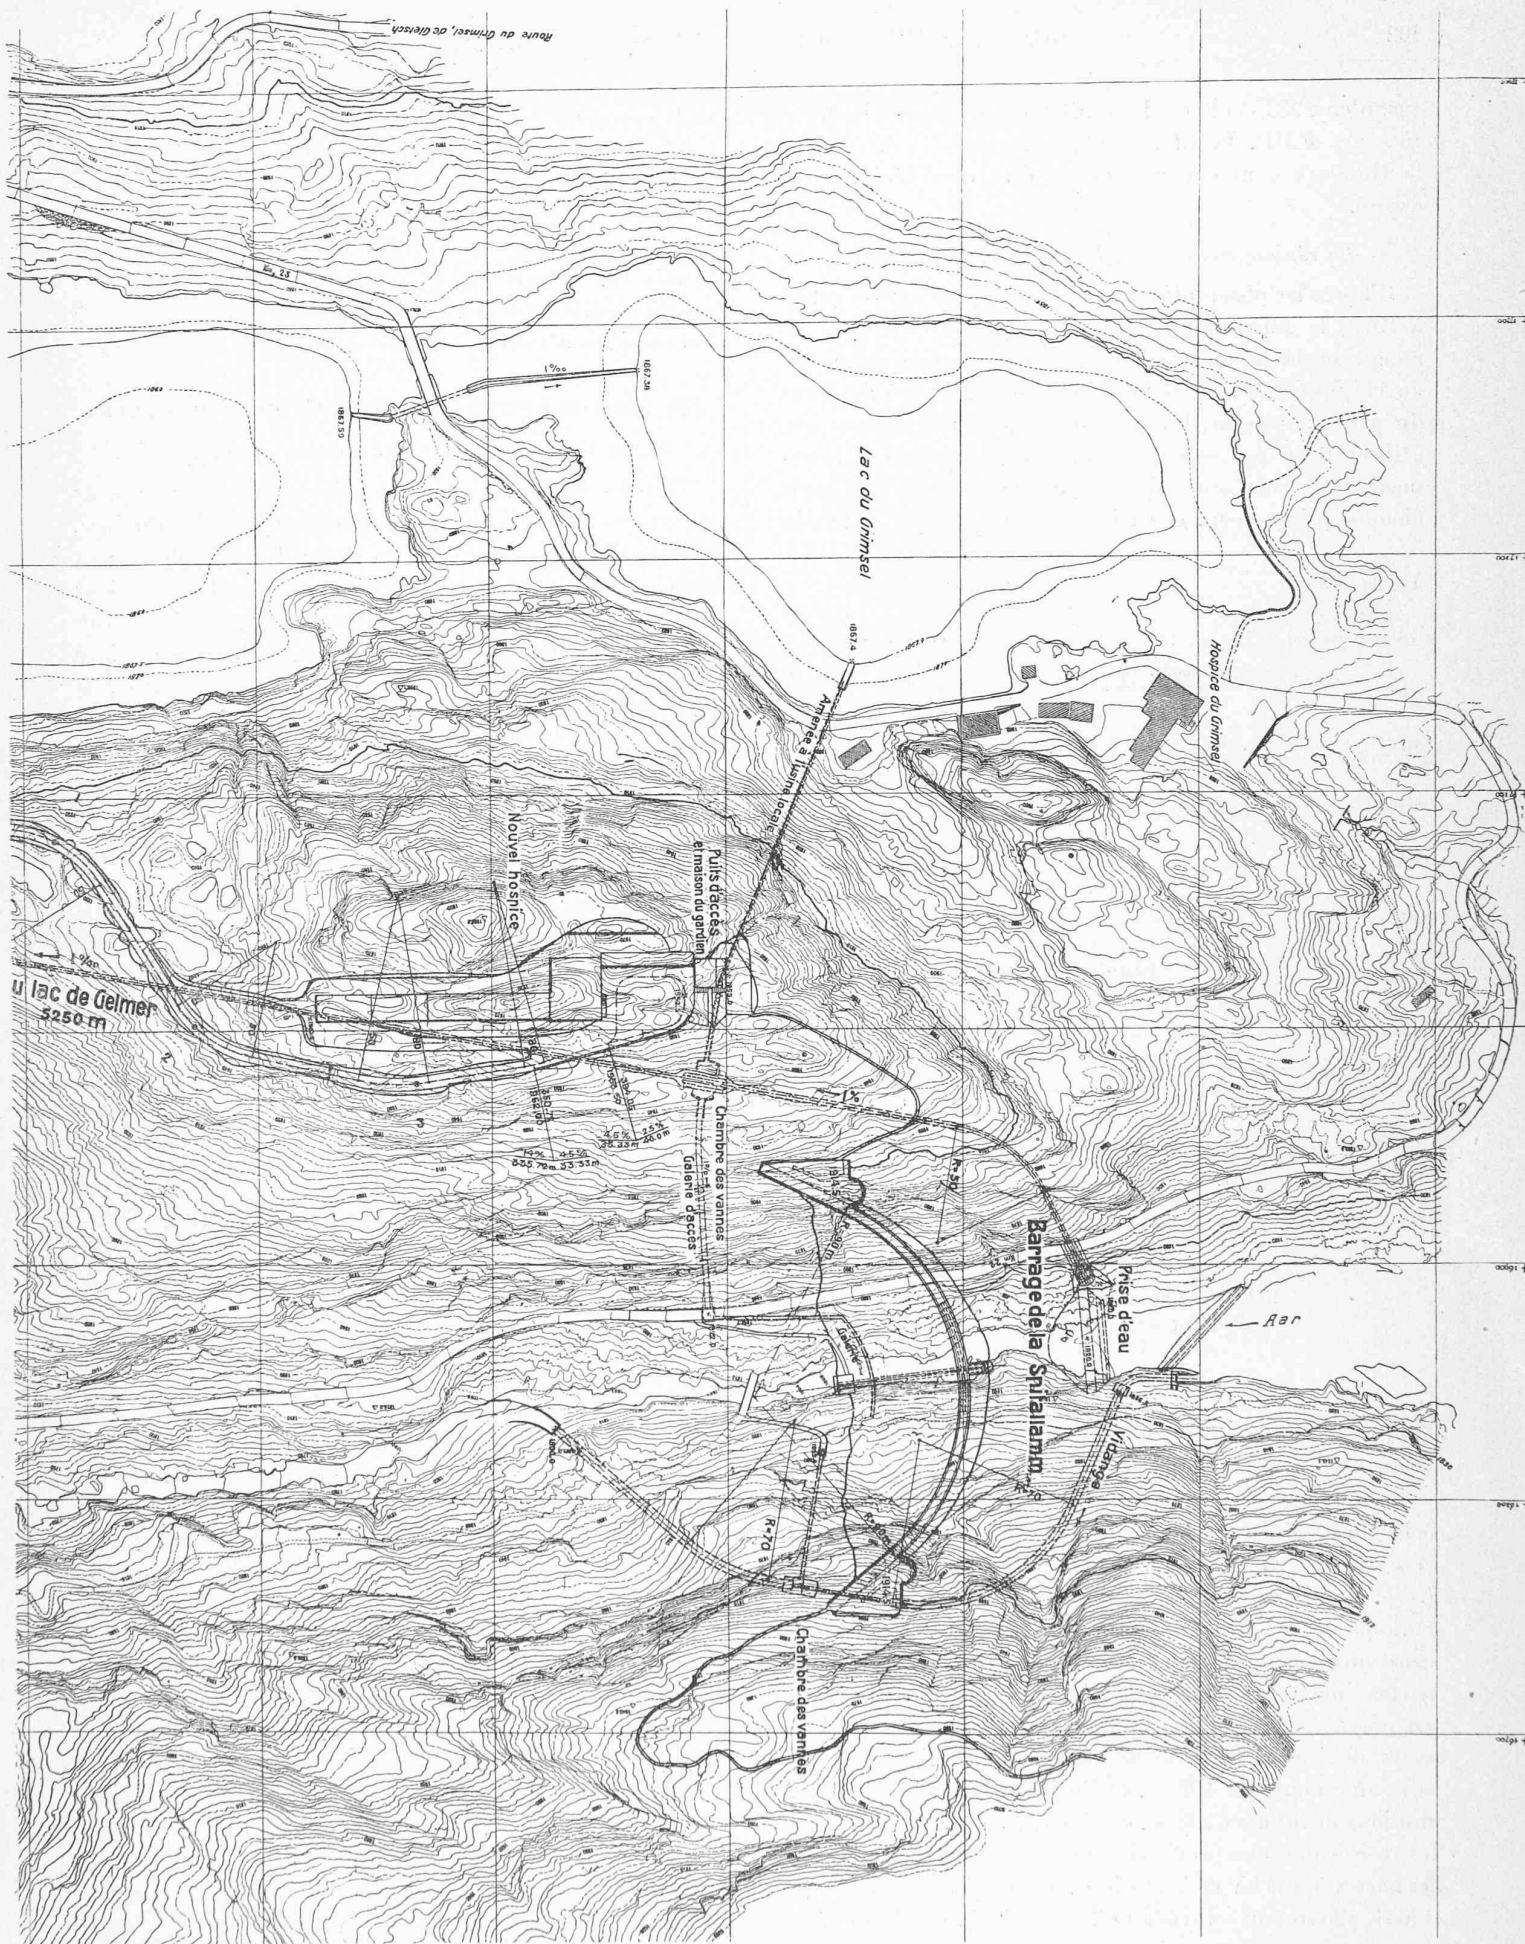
Plan de situation du barrage principal (Spitallam) et du barrage auxiliaire (Seeuferegg).
